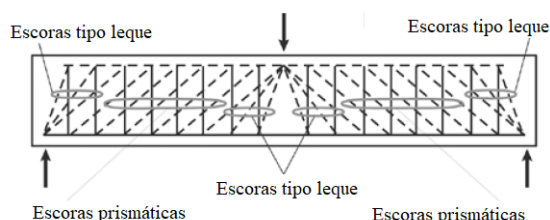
Distribuição dos tipos de escoras em uma viga simplesmente apoiada. Fonte: (Beres and Rabbat, 2007)
